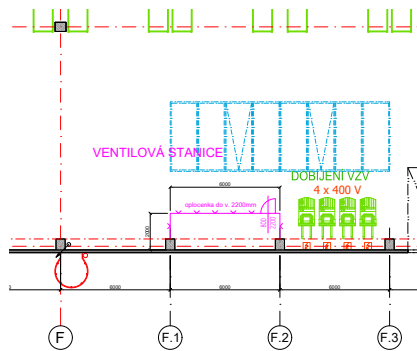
Hala D8-7A půdorys 1.NP celek [14]
